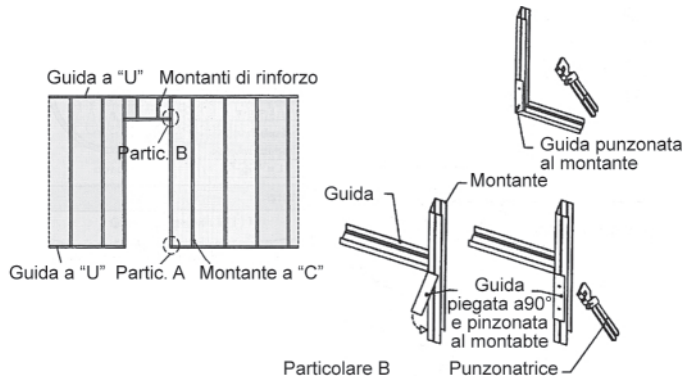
Esempio disposizione profili e lastre per la realizzazione di aperture
